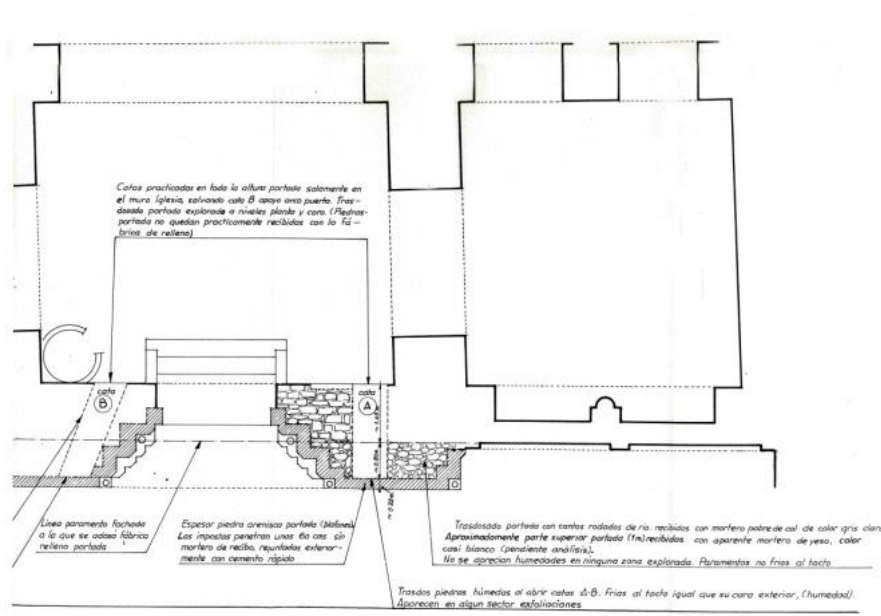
Ripoll Monasterio de Santa María AAFV. Plano de planta de la portada con situación y leyendas de las excavaciones propuestas
